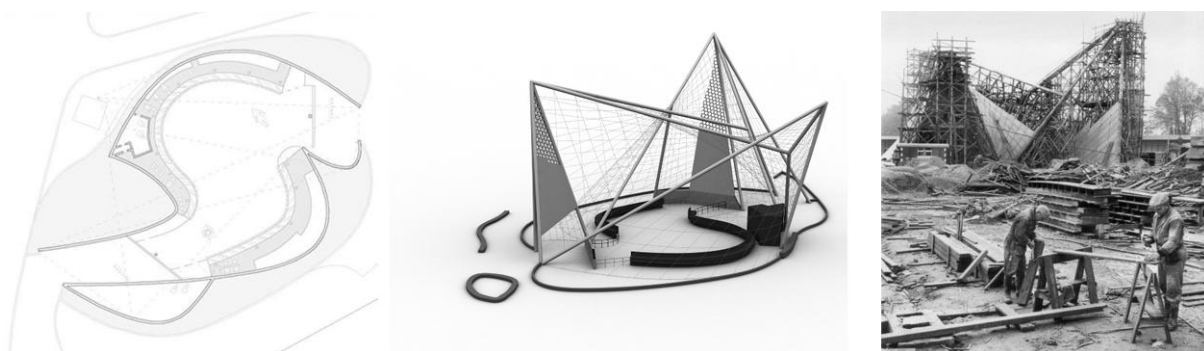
Planta (ESTROLABIO, 2011); Maquete (CARGOCOLLECTIVE, s.d.), Construção (STERKEN, 2004, p. 64)
